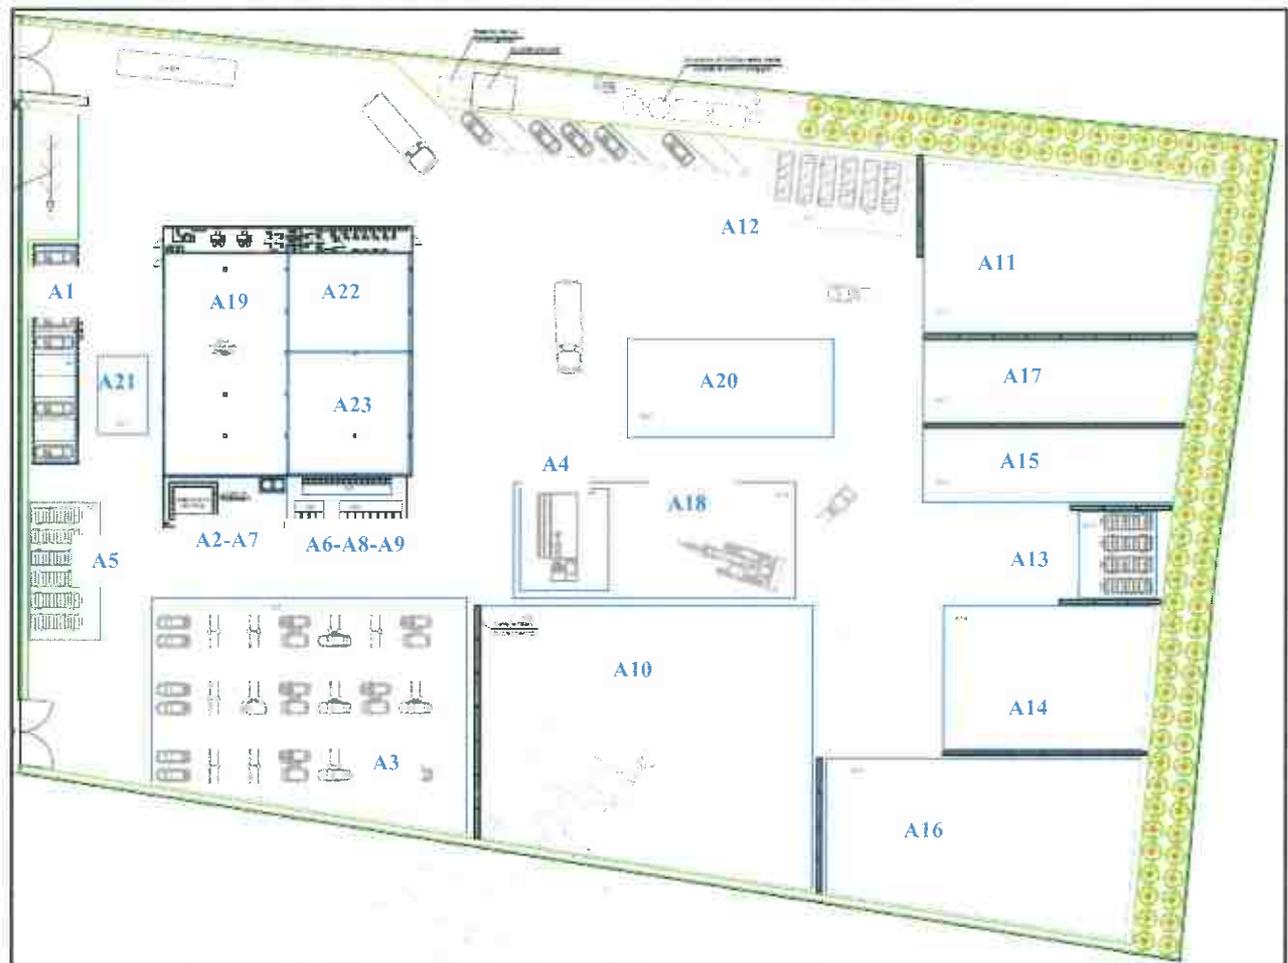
, Layout dell'impianto (da Tav. 2 allegata allo SPA).
